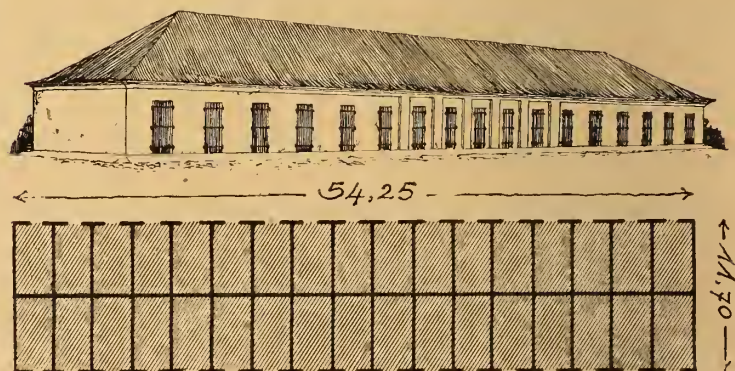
Wylkowyschki. Schaubild und Grundriß.
